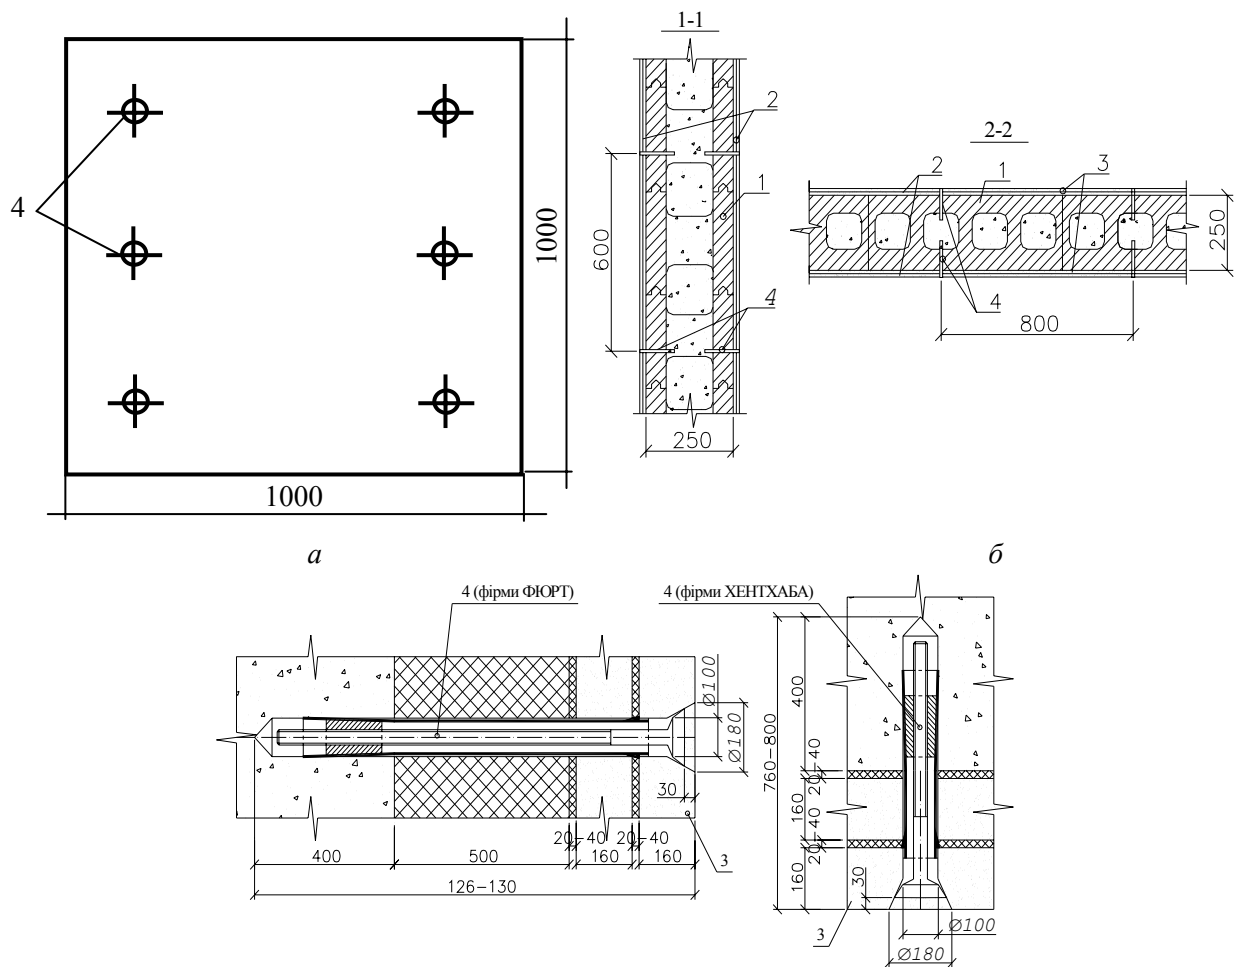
Конструкція експериментальних зразків: а – фрагмент внутрішнього фасаду стіни; б – перерізи стіни; в – конструкція дюбелів; 1 – стінові пінополістирольні блоки; 2 – два шари гіпсокартону $2 \times 12,5 = 25$ мм; 3 – будівельний гіпс; 4 – кріпильні дюбелі
